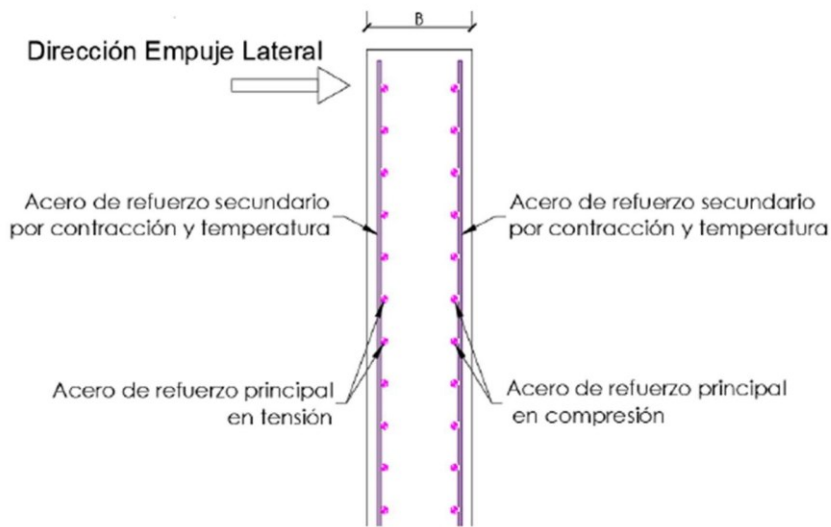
Esquema de reforzamiento del muro de contención tipo mixto siguiendo los esfuerzos principales generados por las condiciones construidas
